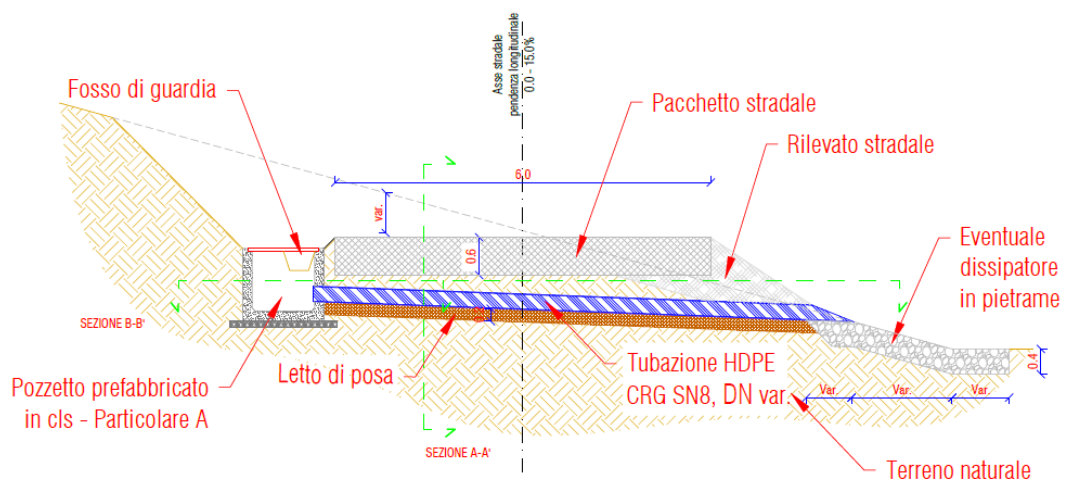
Estratto da tavola di progetto - Attraversamento stradale di scarico
